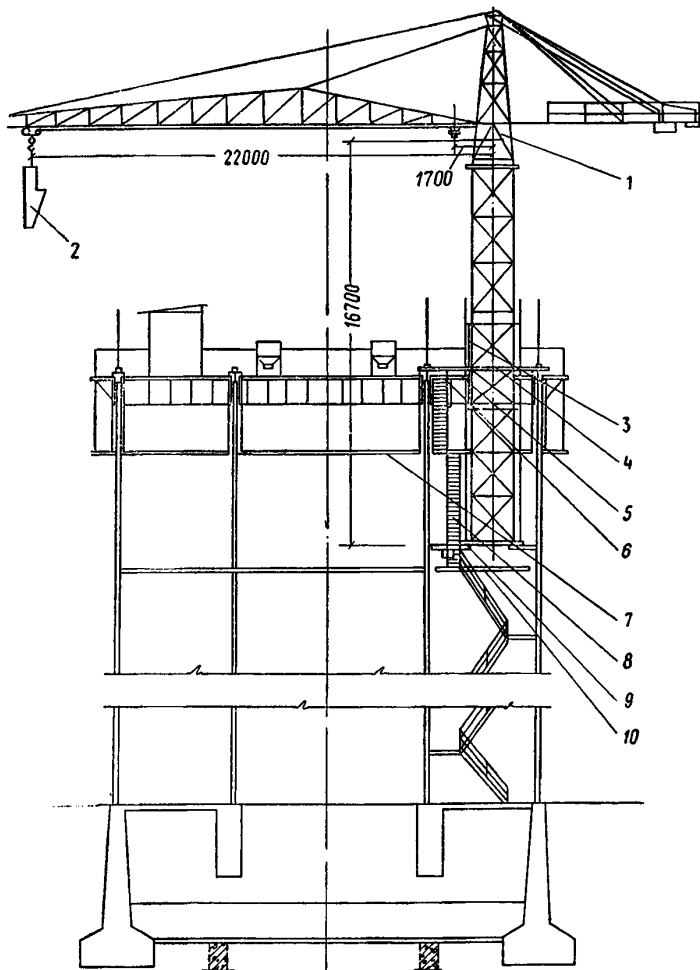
Бетонирование копра с помощью самоподъемного крана УБК-3-49
